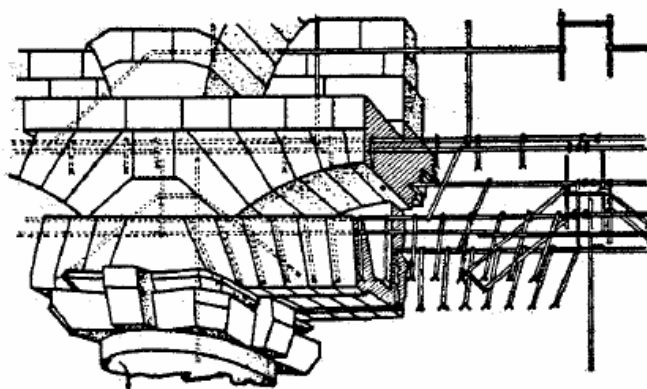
Alvenaria de Pedra armada, Pantheon em Paris (KAEFER, 1998).
